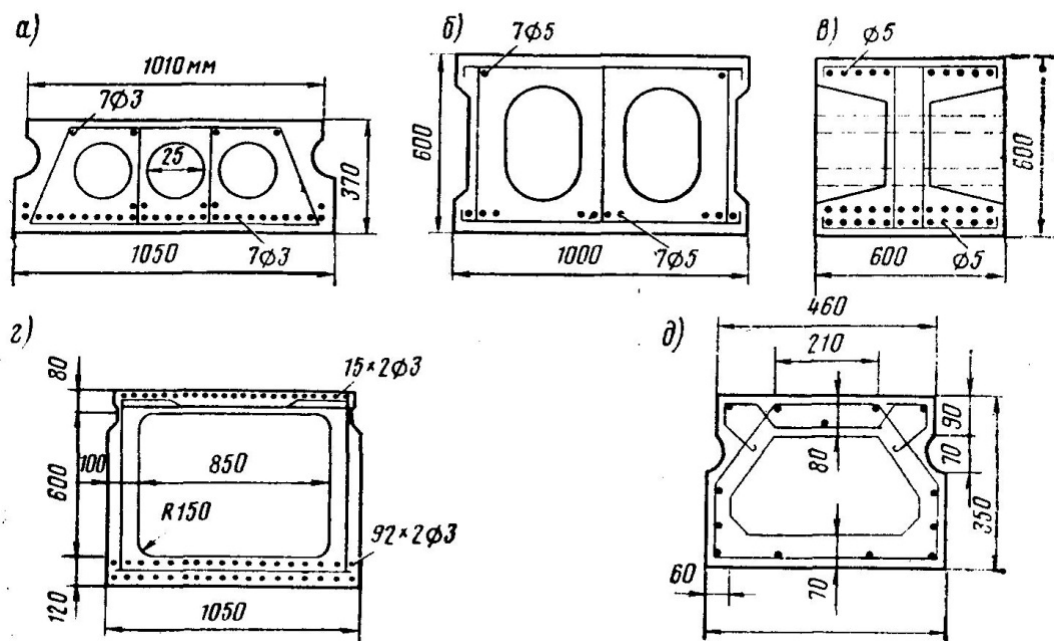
Поперечний переріз балок прогонових будов (тип б).
